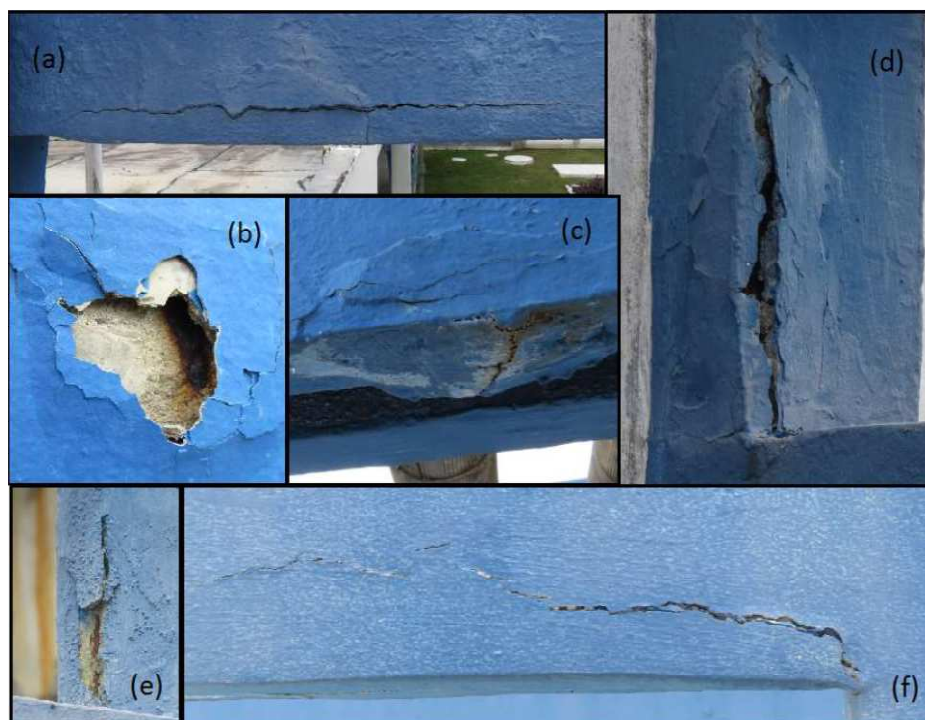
Manifestações patológicas nas vigas Vierendeel de dano grave: (a, f) fissuras, (b, e) exposição da armadura, (c, d) deslocamento do concreto.
